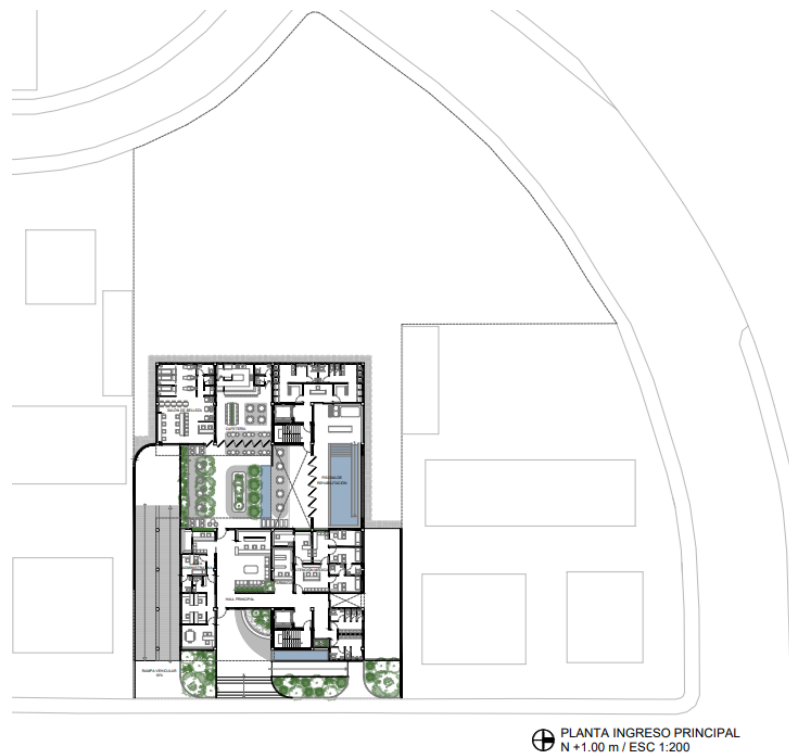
Planimetría: Planta Ingreso Principal (N +1.00 m)
